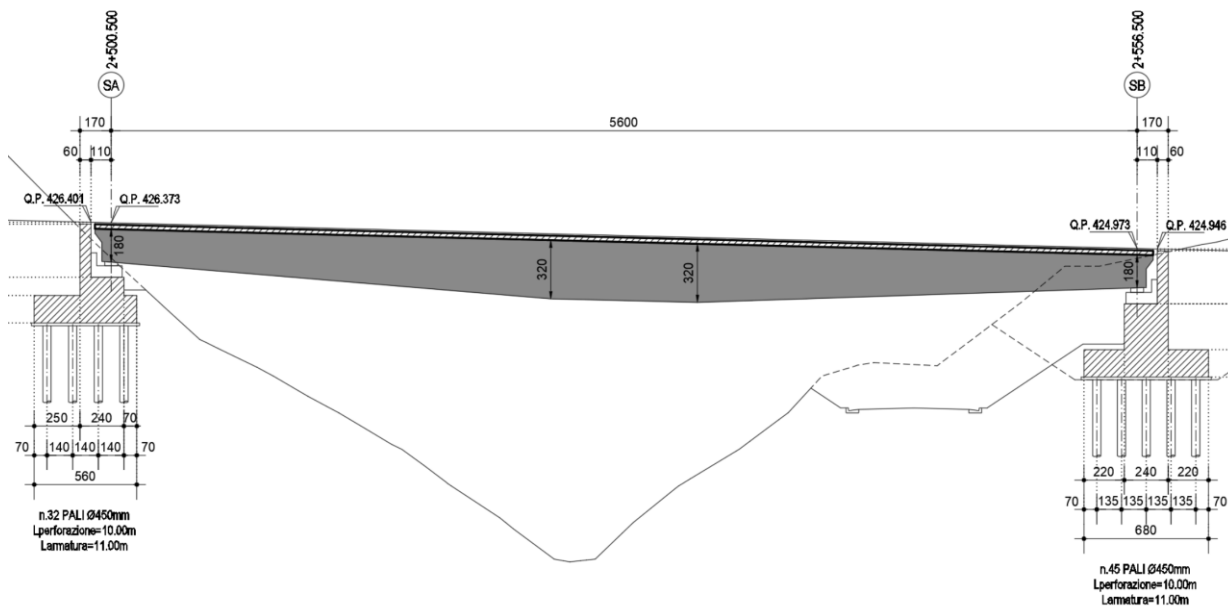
Sezione longitudinale lungo asse tracciamento
